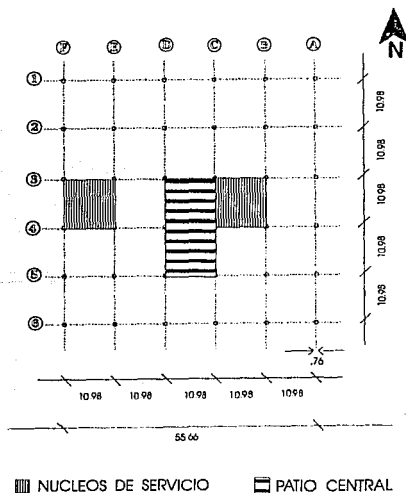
PLANTA TIPO DEL EDIFICIO
